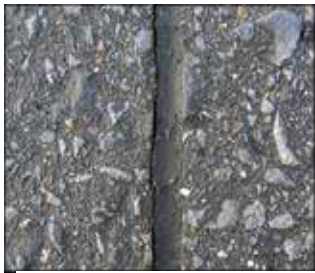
シール材のひび割れ (30 万輪走行後)
